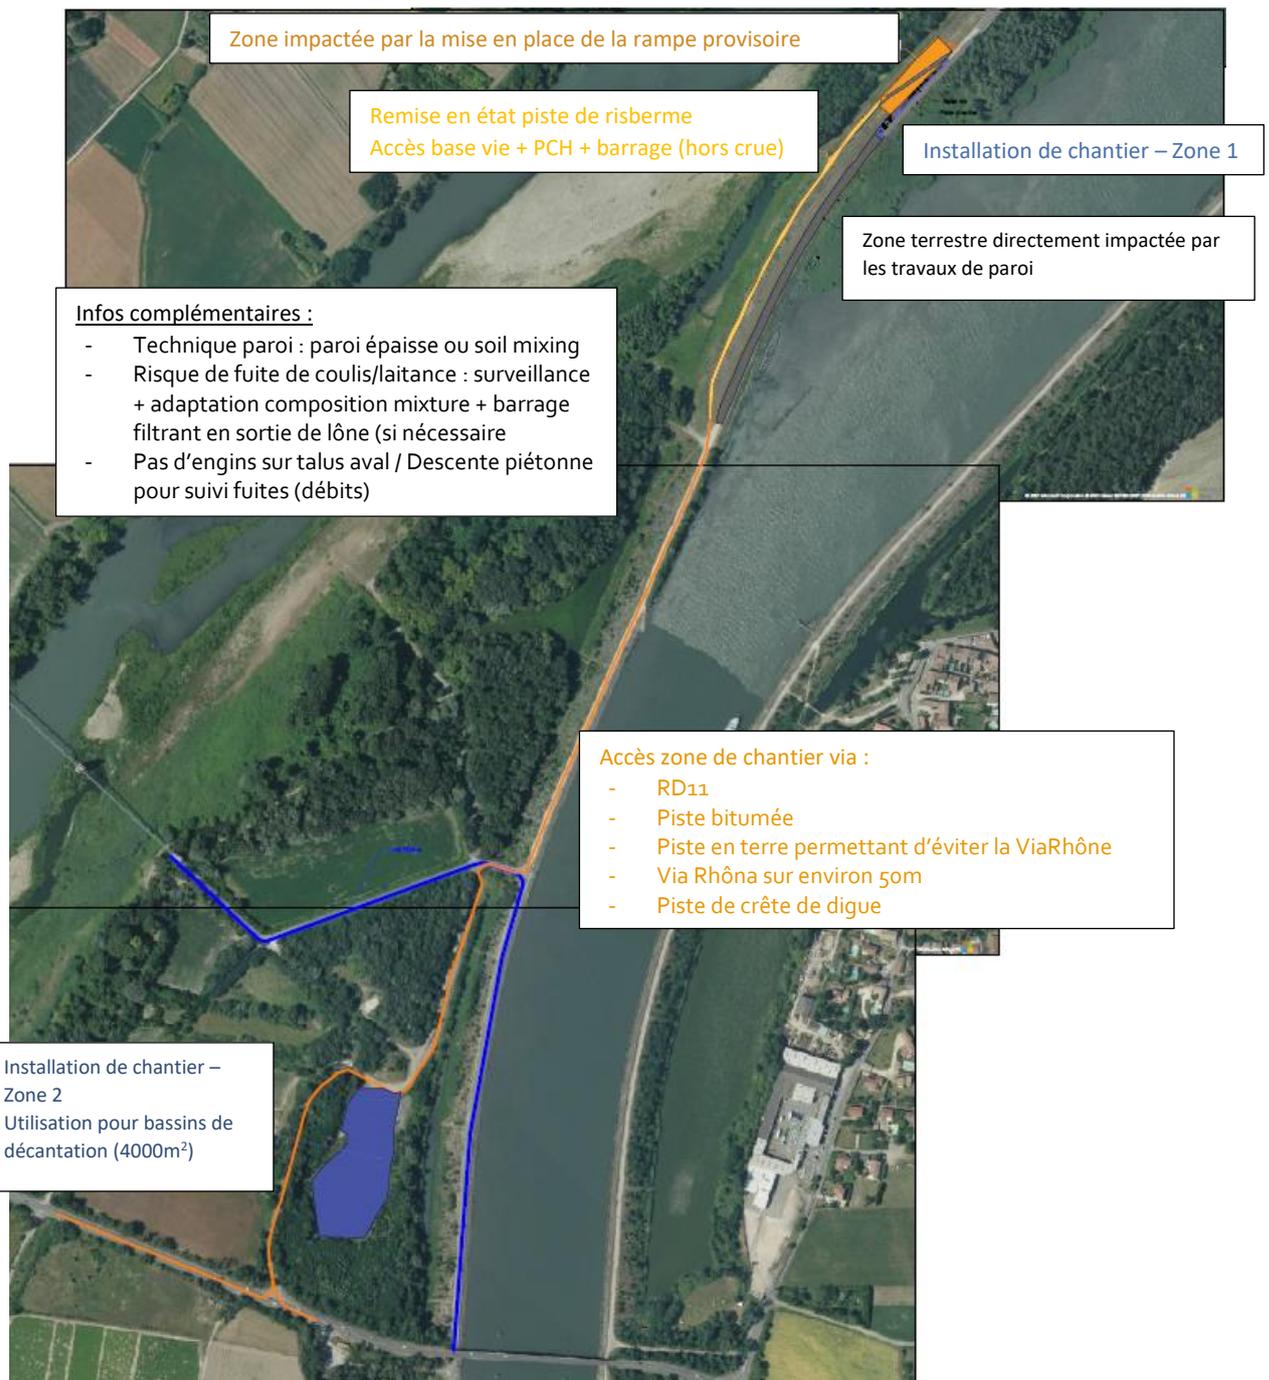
Plan des travaux de la phase 2 (source CNR)
